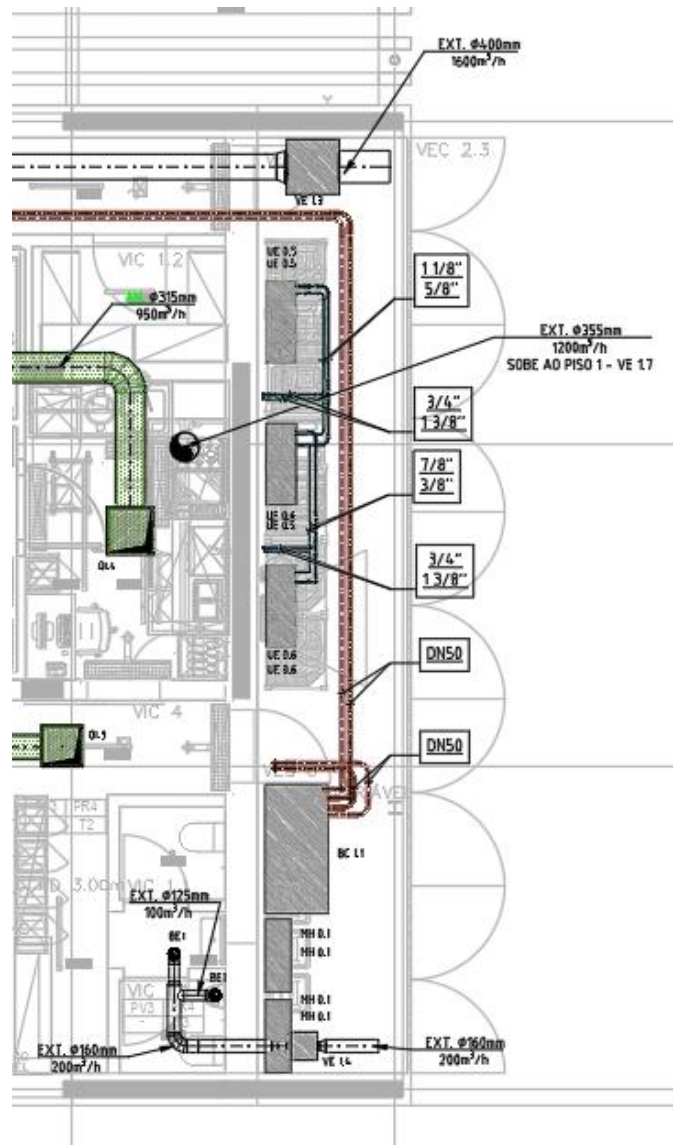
Preparação da área técnica exterior do piso 0 do restaurante
